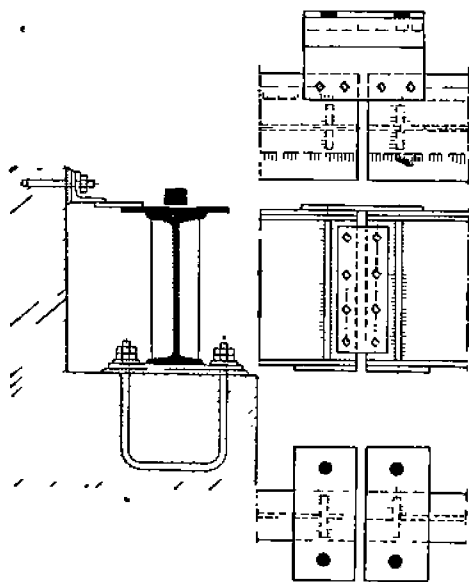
Крепление подкрановых балок к железобетонным колоннам
